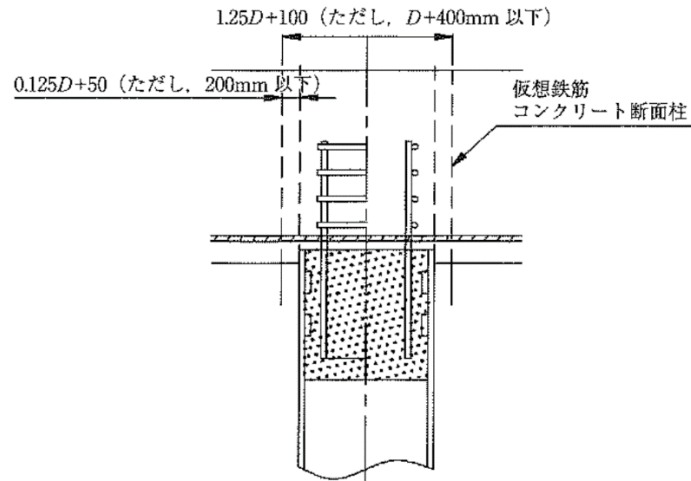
仮想鉄筋コンクリート断面
